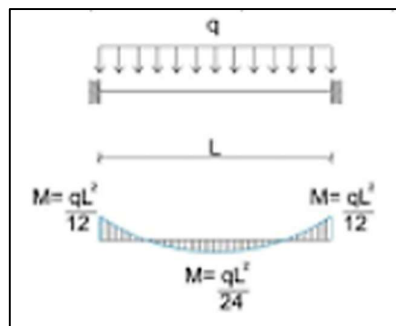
Viga empotrada a los extremos con carga distribuida
